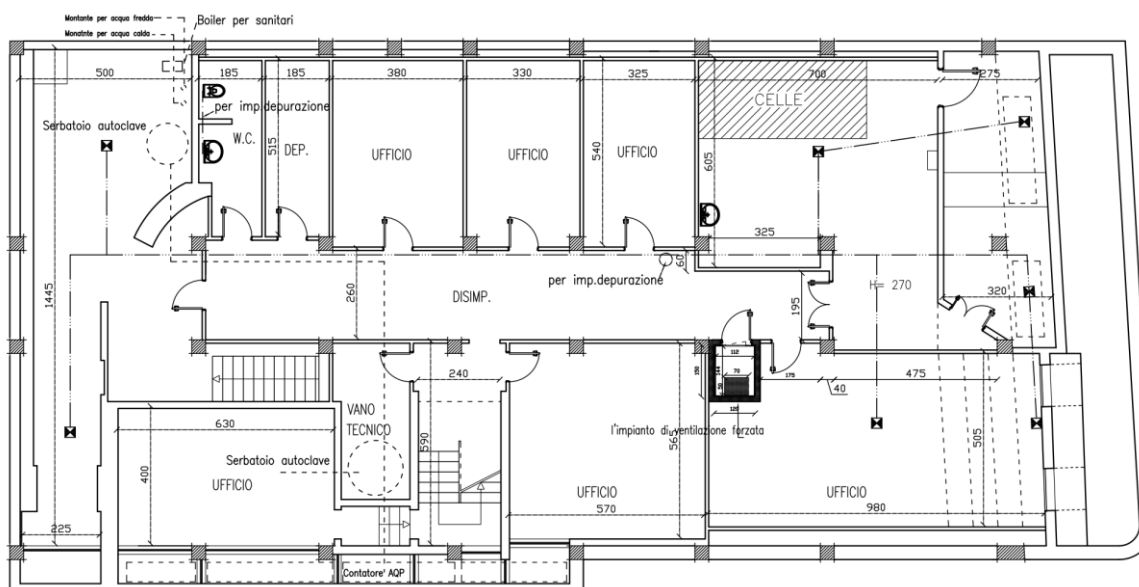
Planimetria Laboratorio carni di Via Dante 1/E, Comune di Casamassima (BA)
